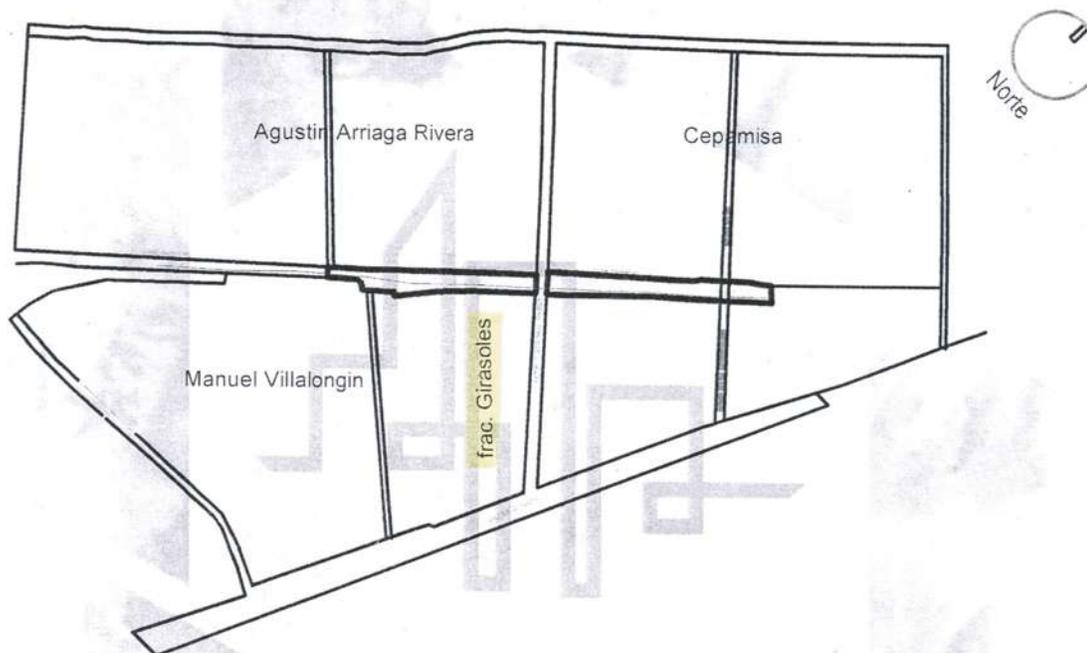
PLANTA DE CONJUNTO, CONSTRUCCIÓN PROPIA
